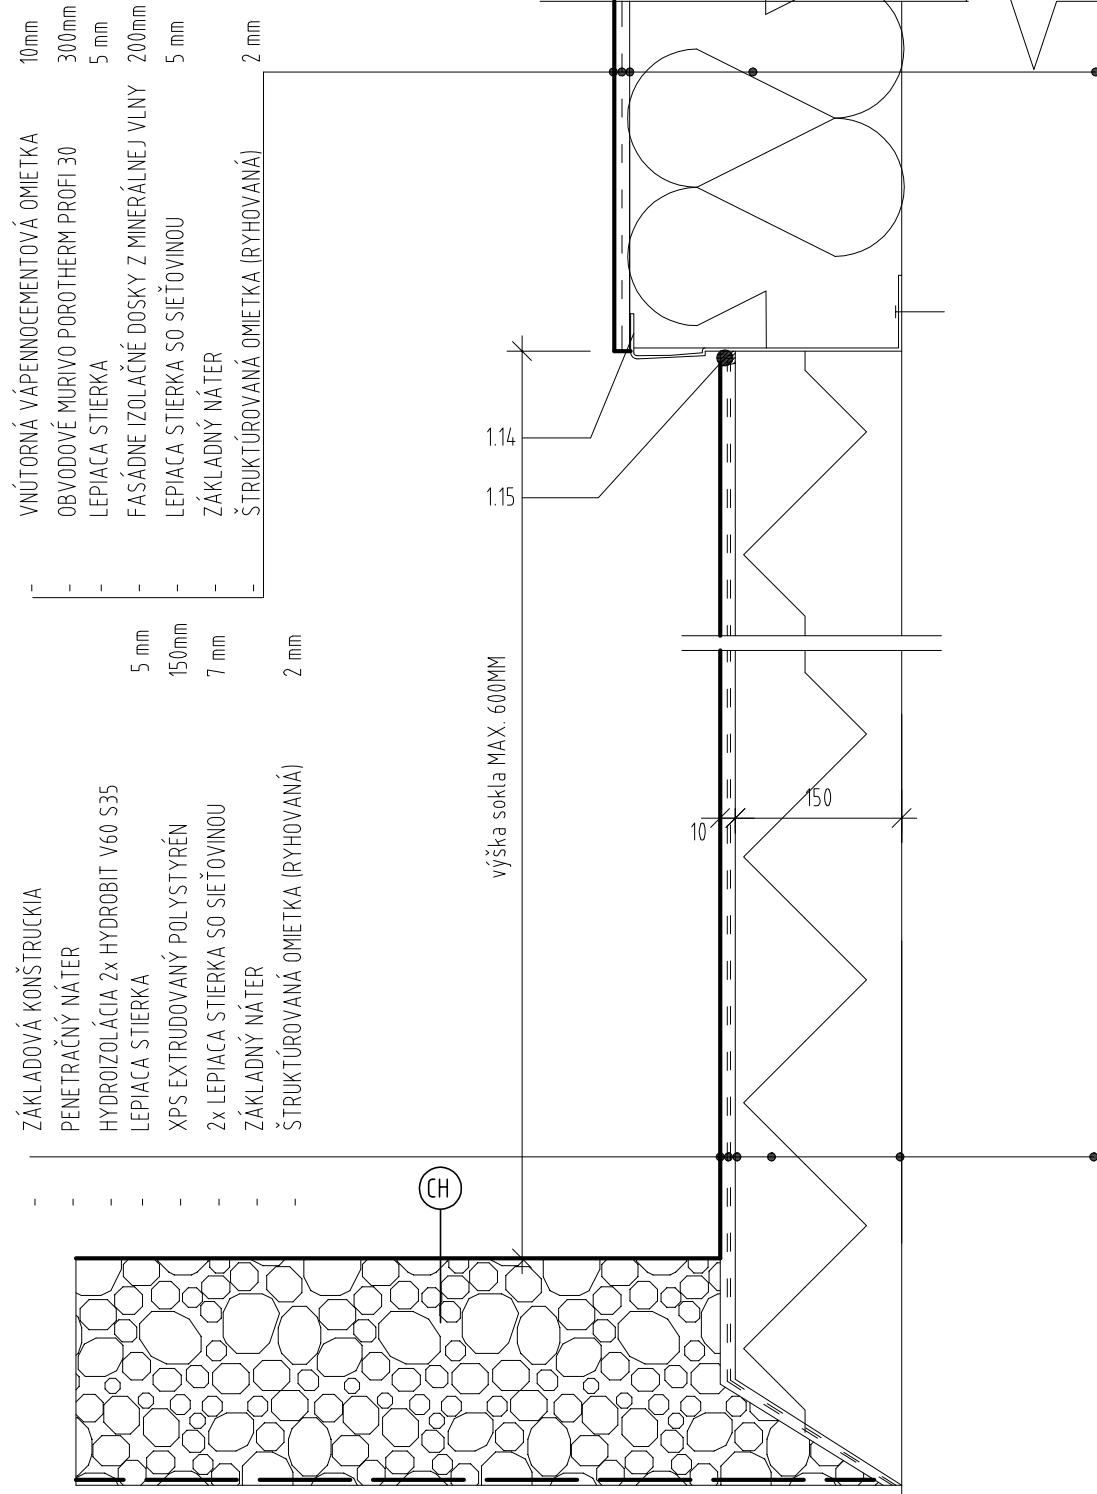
DETAIL KÚTA SOKLU / Extrudovaný polystyrén, hr. 150 mm
